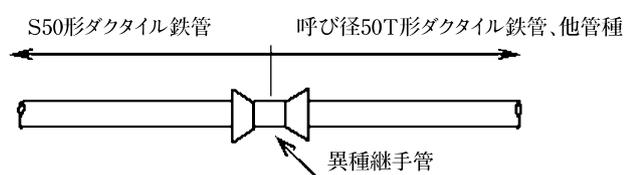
呼び径50T形ダクタイトイル鉄管や他管種との接続方法例
